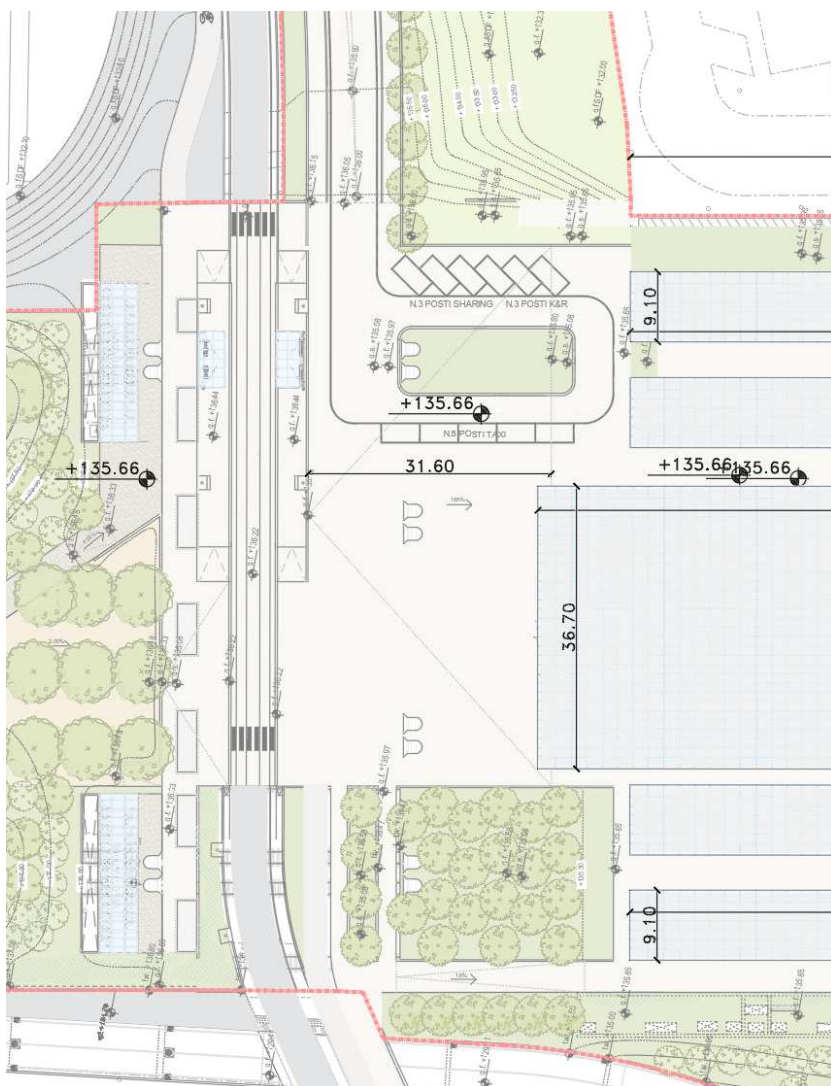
Estratto planimetria piano ingressi – piazzale nord
